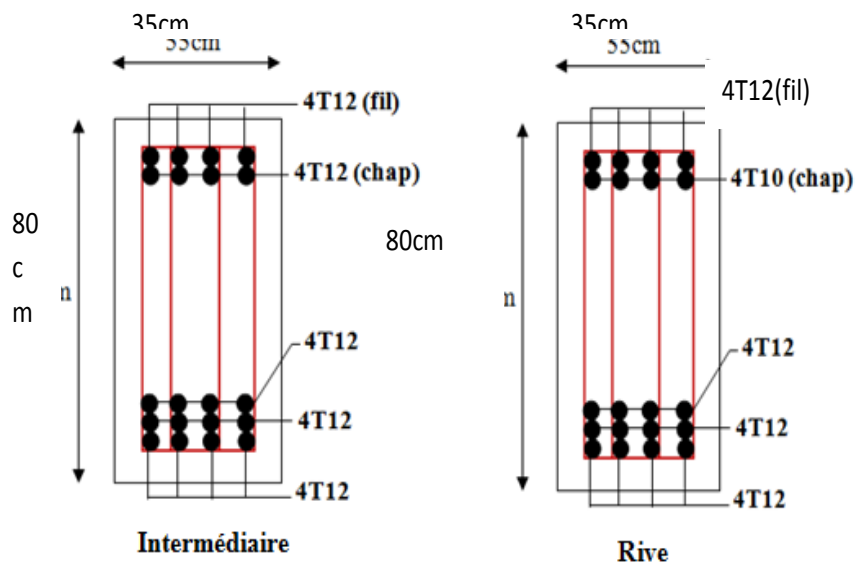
Ferrailage de la poutre de libage suivant le sens transversal.
